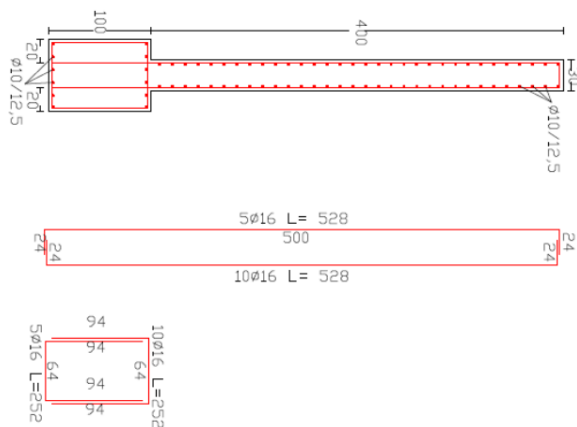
Dimensões e Ferragens da Parede Tipo Berlim
